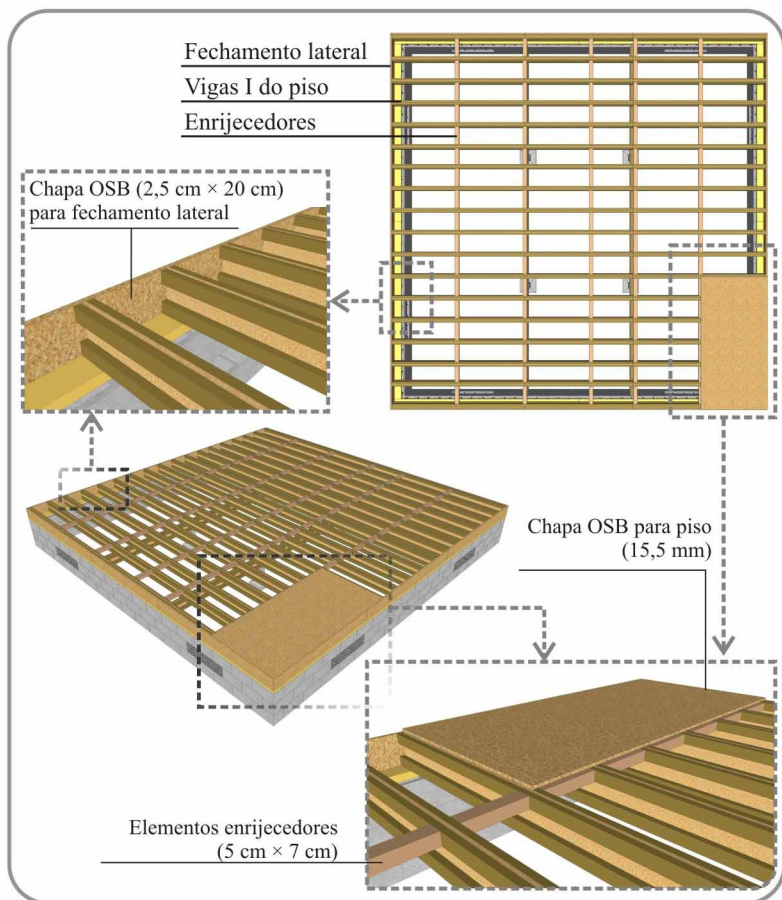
Detalhes da chapa de fechamento lateral e dos elementos enrijecedores entre vigas do piso
